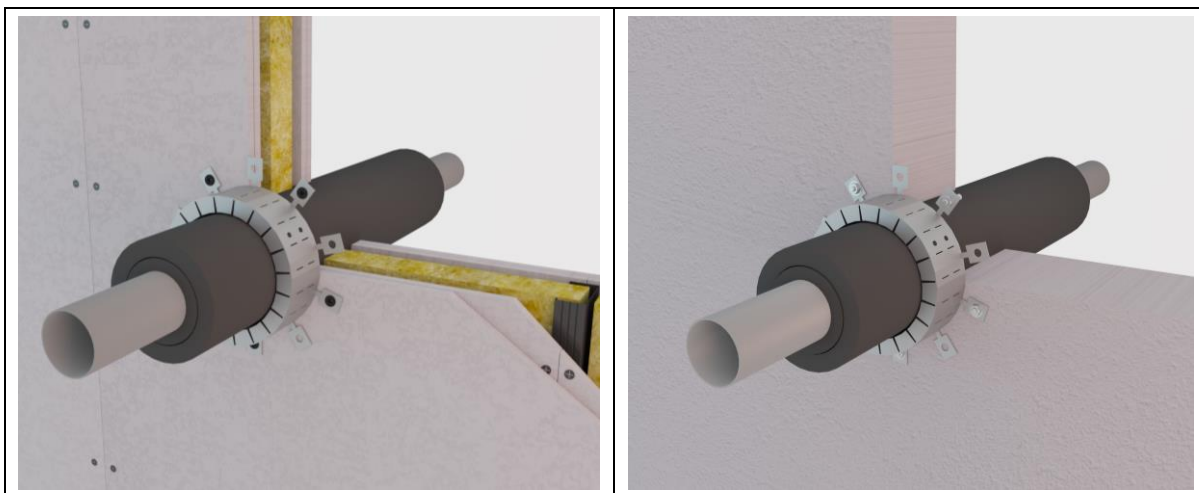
Ejemplo de sellado de penetración de tubería metálica aislada en una pared flexible o rígida.
